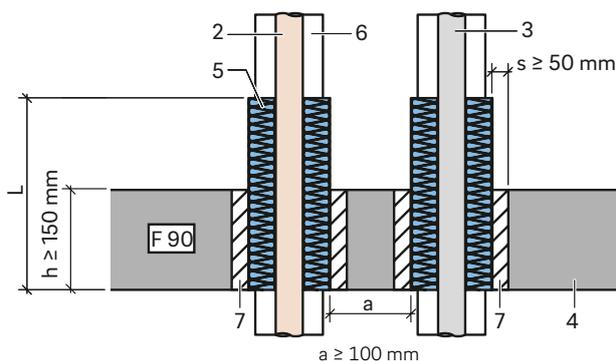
Installation asymétrique dans un plafond massif - face supérieure du plafond
